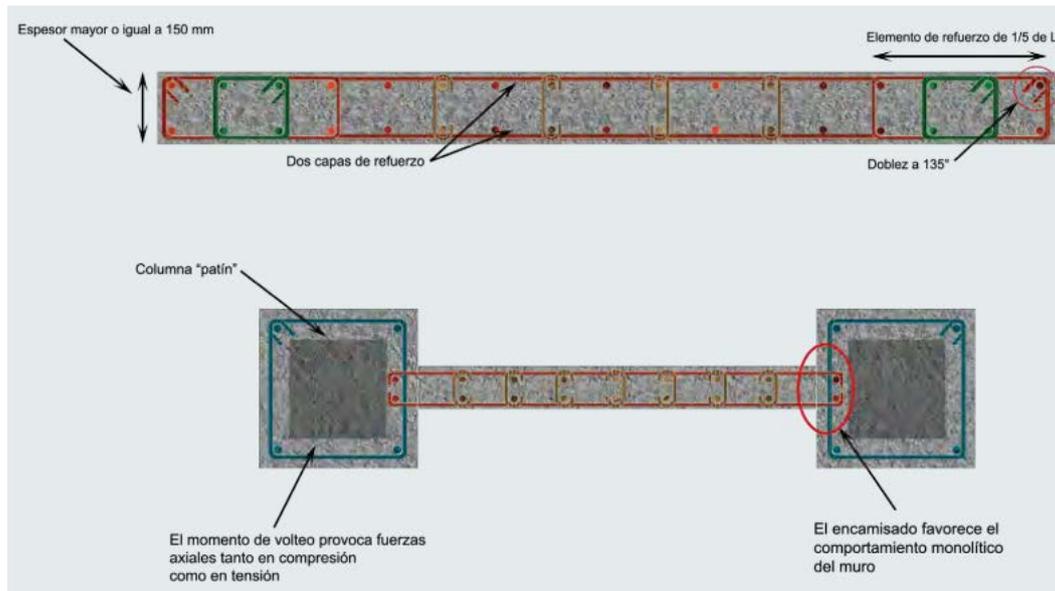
Refuerzo de extremos o adición de muro entre pilares.
